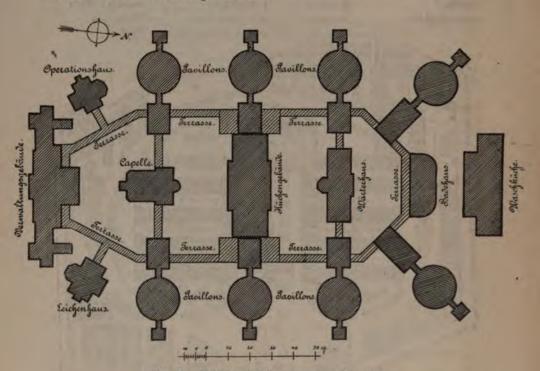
Civil-Hospital in Antwerpen. Lageplan.
